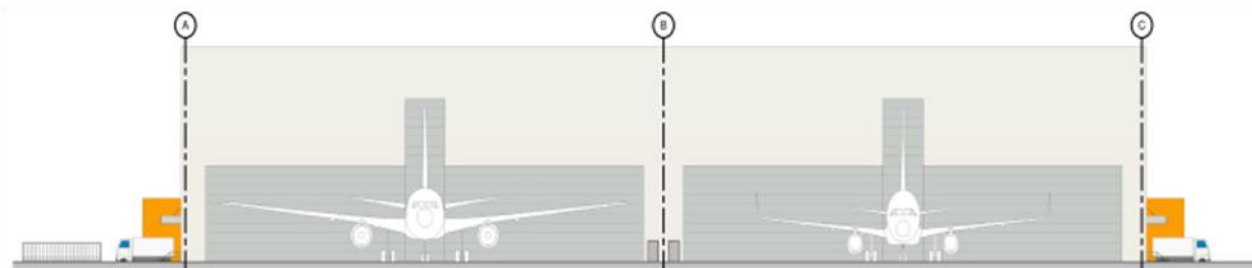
Intervento C2: Strutture area merci, prospetto edificio
